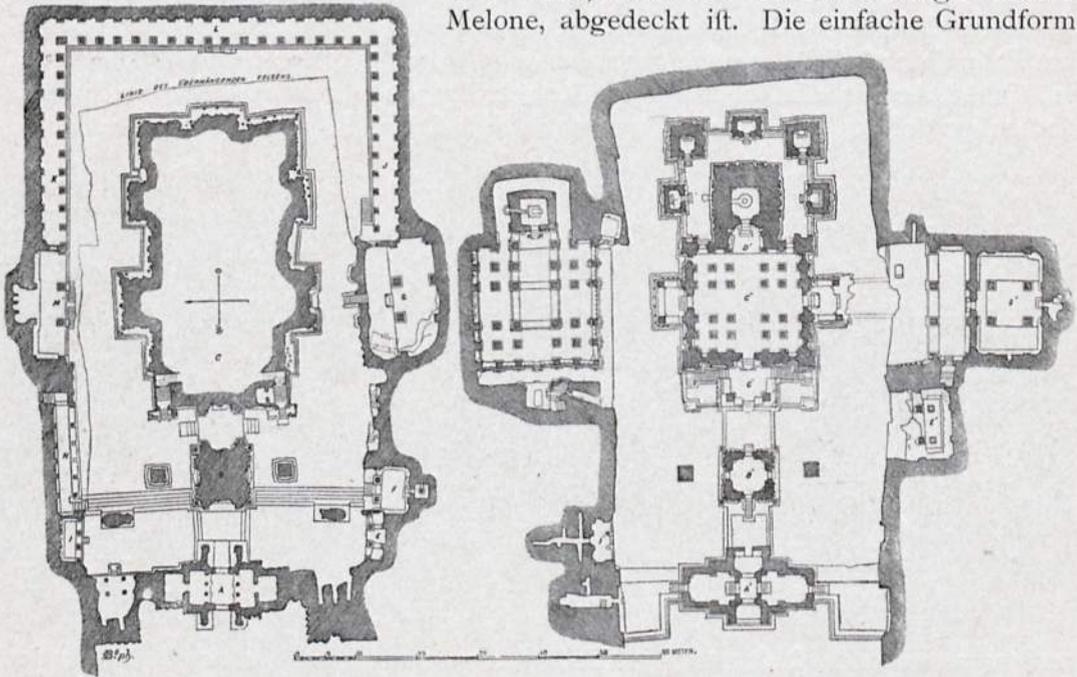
und 120. Kailasa: Grundplan und Plan des Obergeschosses. Nach J. Burgess.
